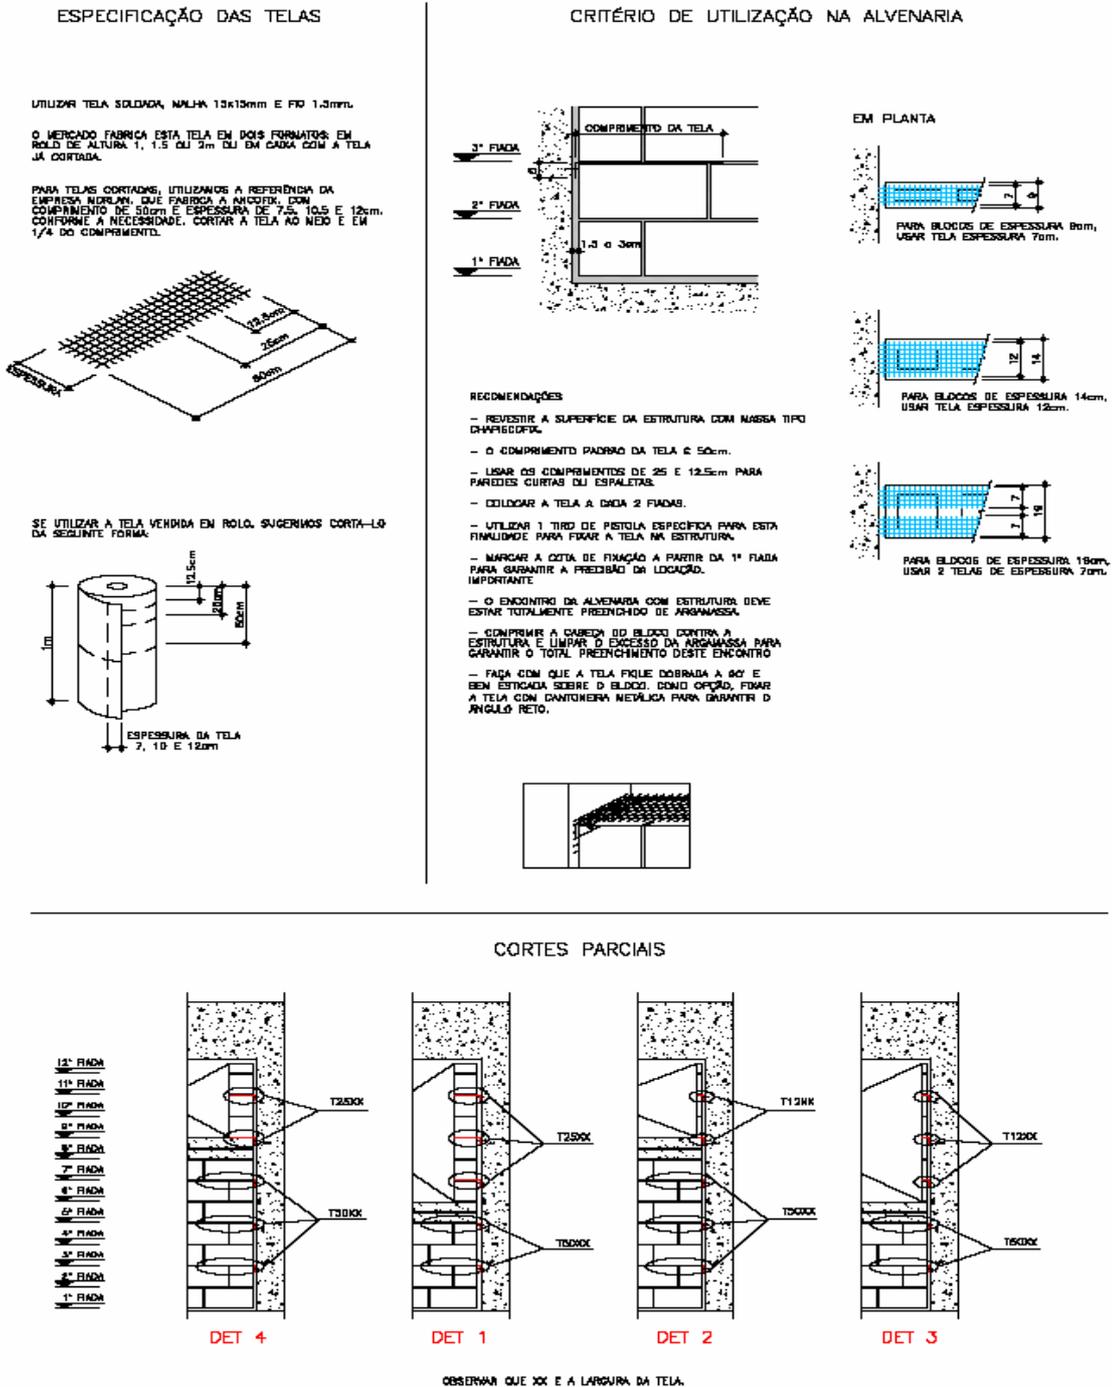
Exemplo de detalhamento de telas de amarração de um PPVA
